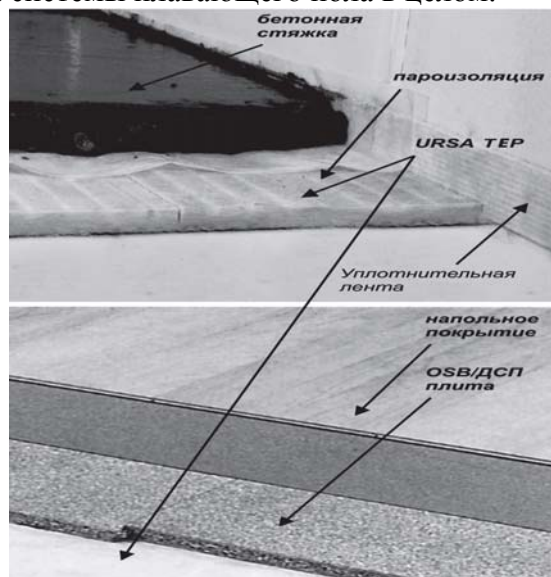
Схема тепло, звукоизоляция междуэтажного перекрытия «под стяжку»
